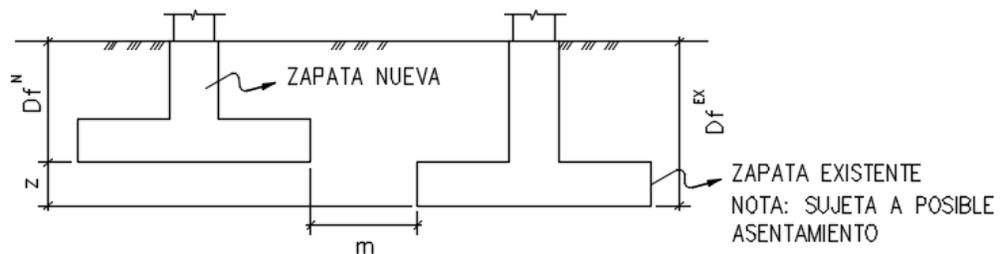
Separación entre zapatas nueva con respecto a una existente, por encima de su cota de su fundación. Fuente: Autores
